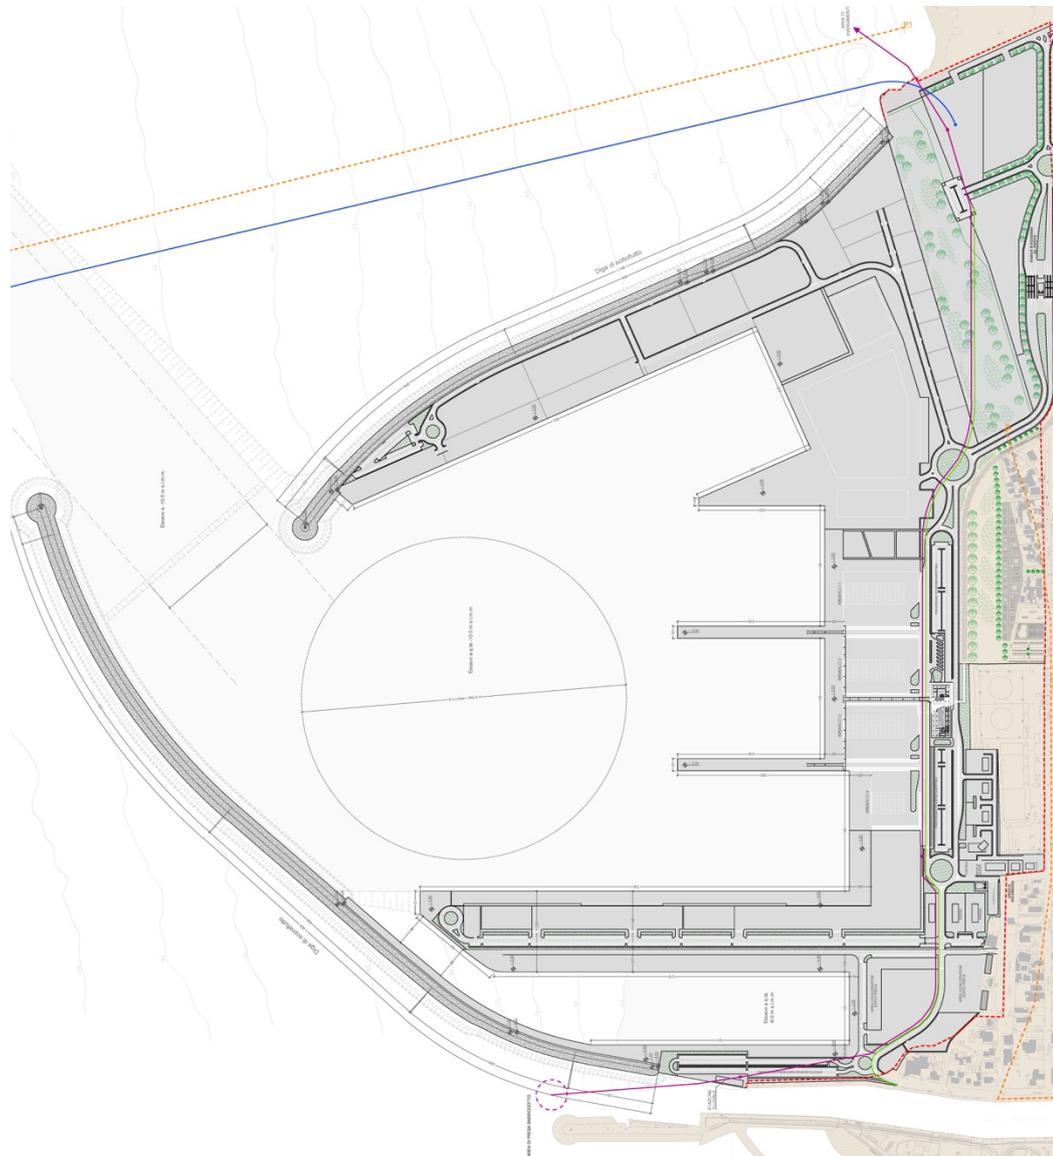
Nuovo Porto commerciale di Fiumicino. Progetto preliminare. Planimetria generale post – operam (Rev.1 – Aprile 2014).
